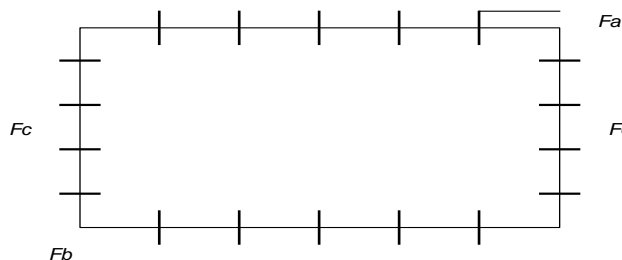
Армирование плиты в пролете(нижняя арматура)
